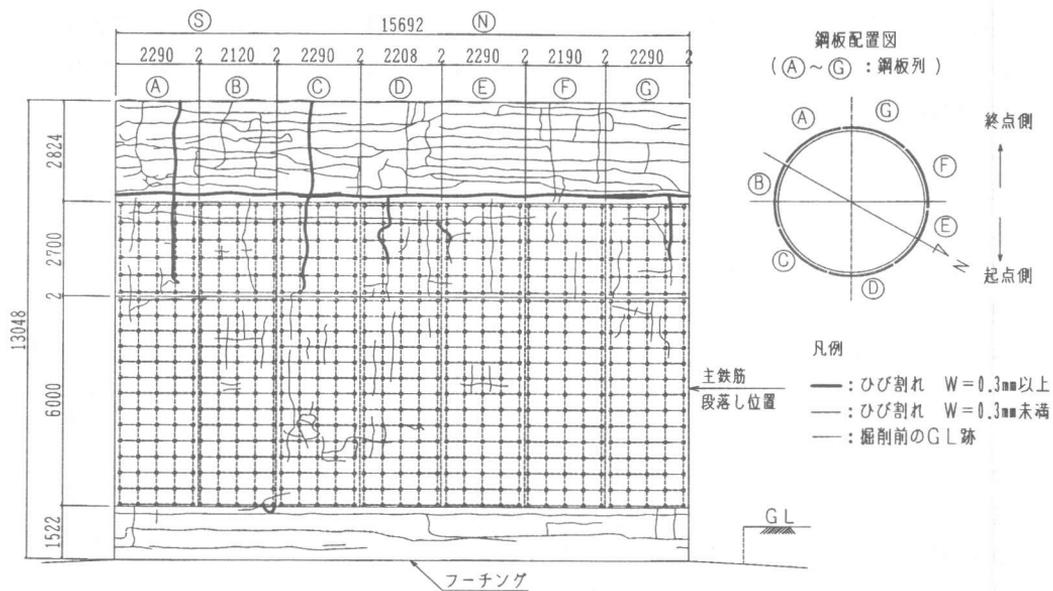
ひび割れ発生状況展開図 (P-176, 二次調査)
